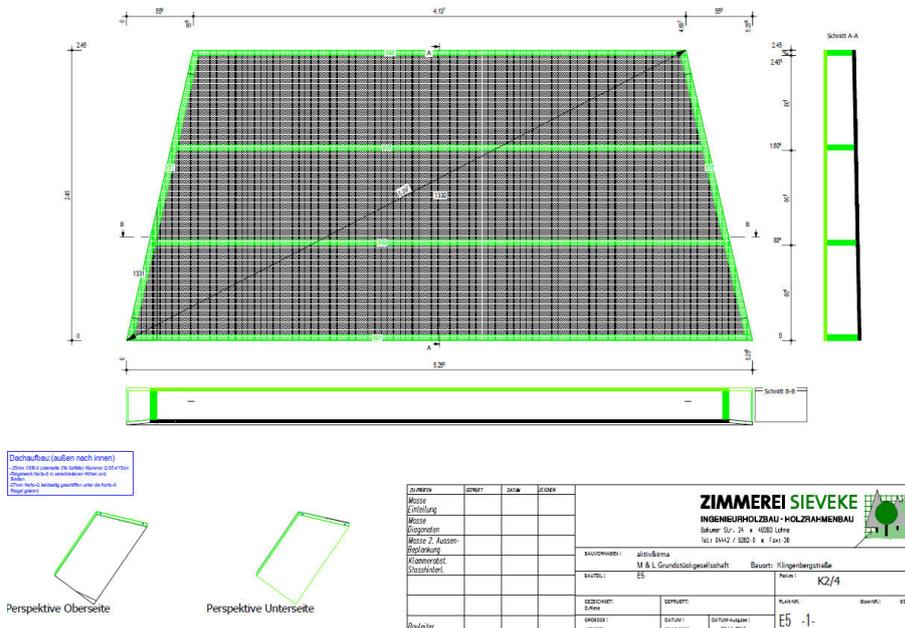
Montageplan (Projekt A)⁴²⁹
